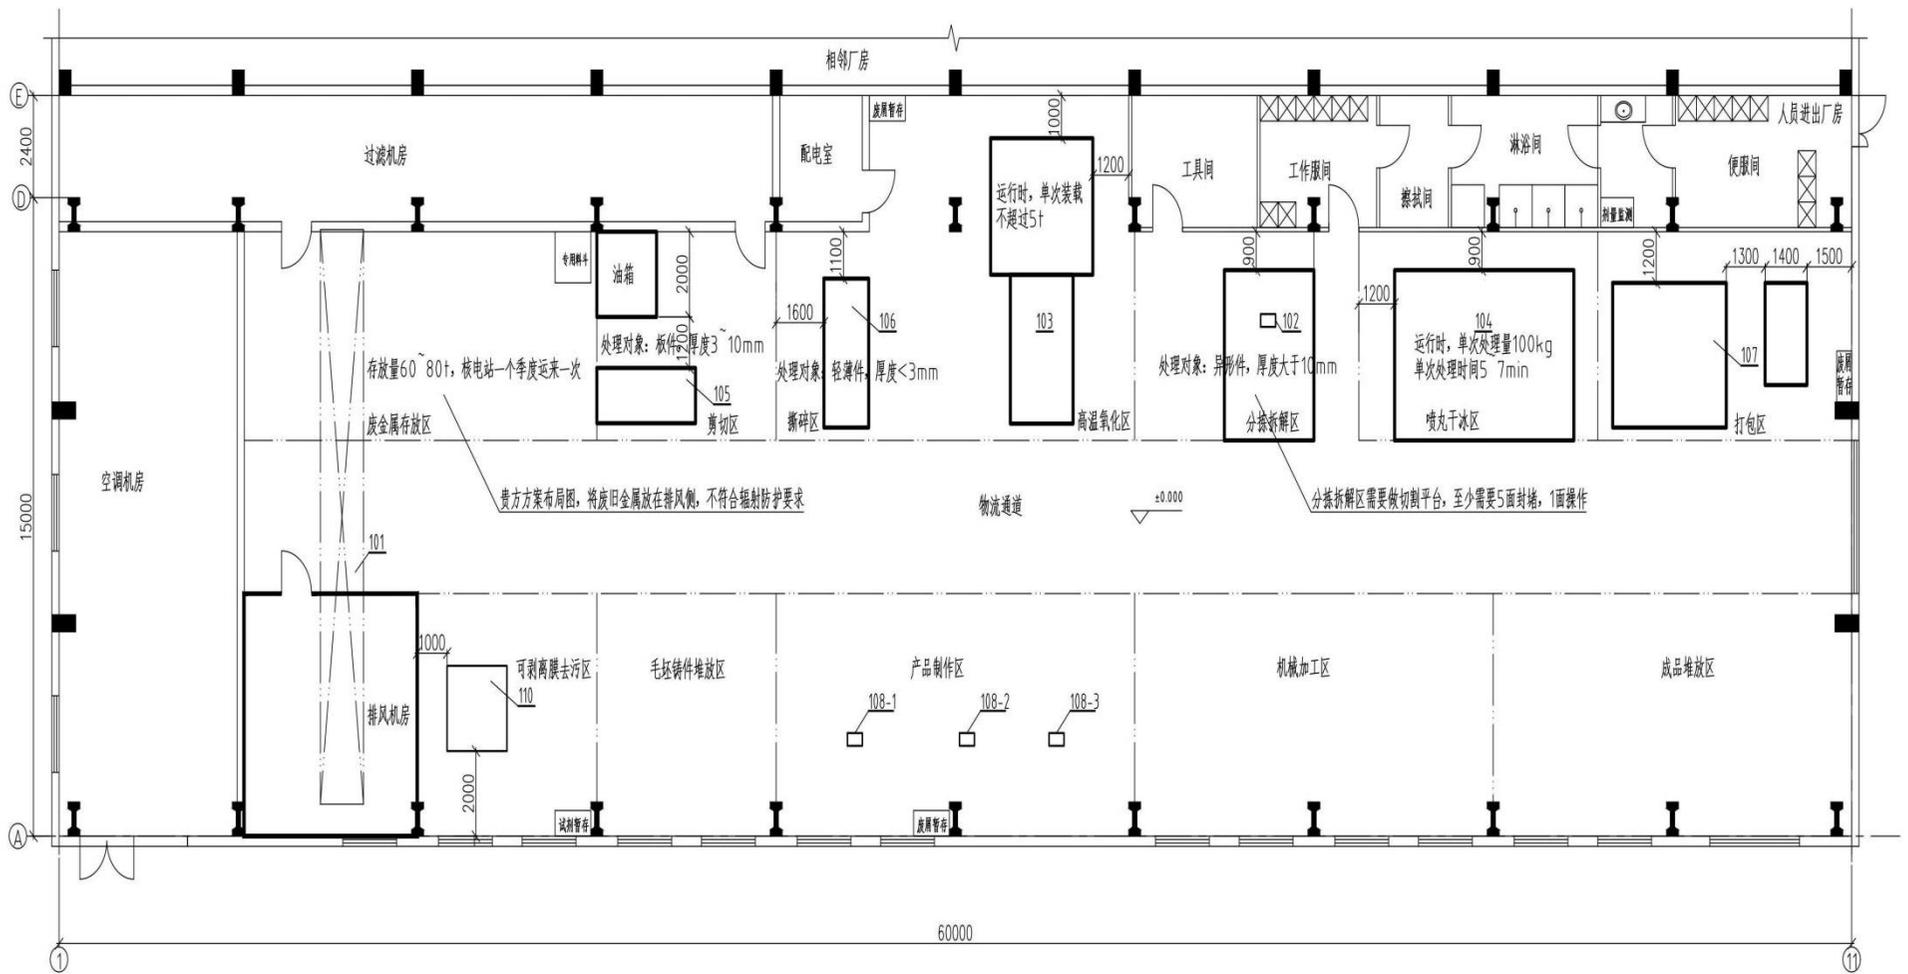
核电站废旧金属循环再利用加工厂房平面布置图
